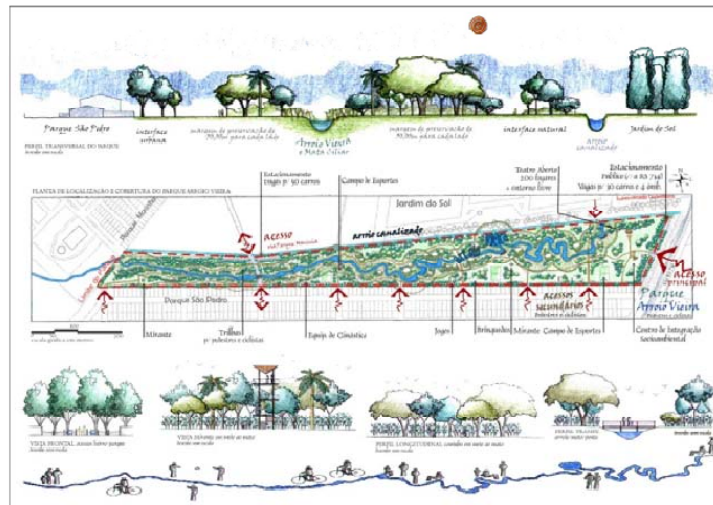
Planta e Perfil transversal do Parque do Arroio Vieira (Desenho Esquemático: Arq Vanessa Baldoni)
